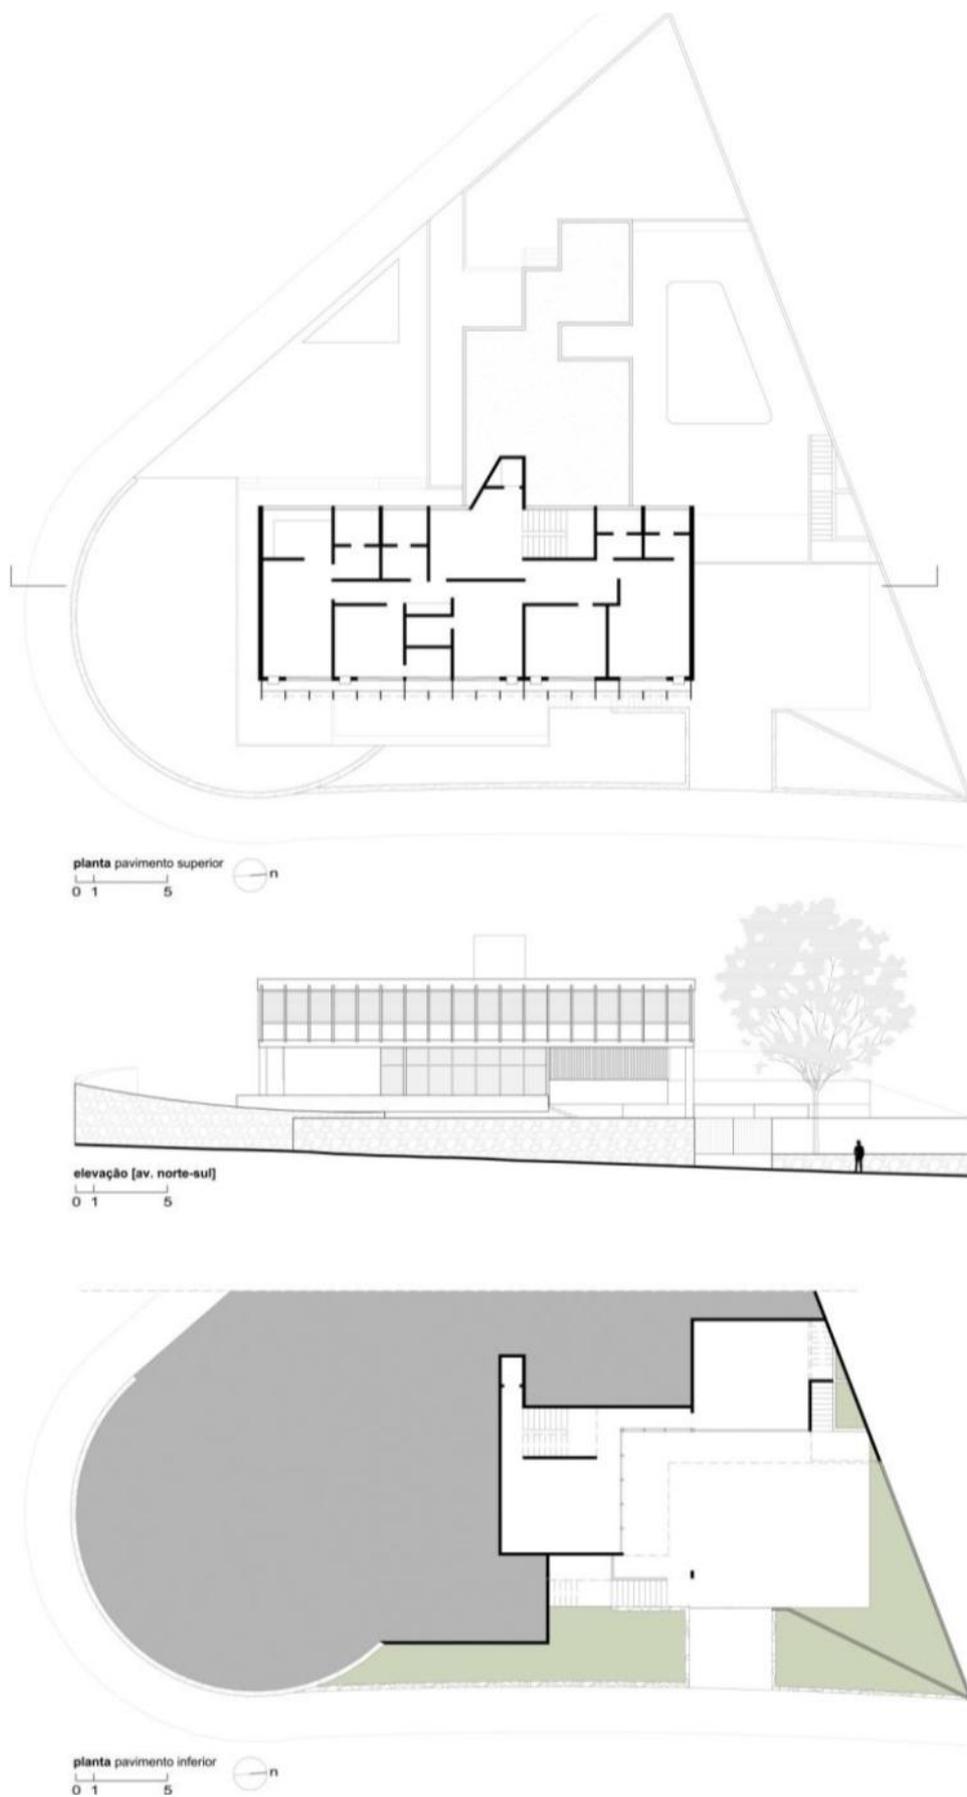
Residência De La Torre. Elevação principal e plantas dos pavimentos superior e inferior. Fonte: Redesenho do autor sobre originais do acervo Gilberto Pascoal.
